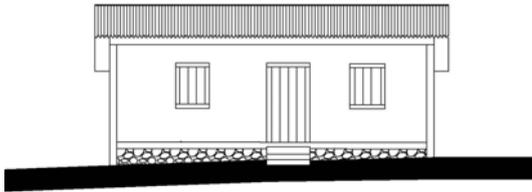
Fachada Sul (Acervo PROAU/FAU/UnB).
